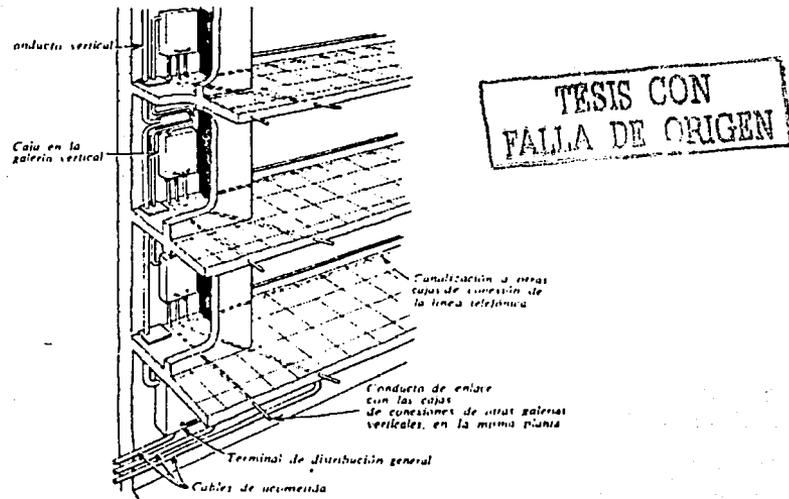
Disposición típica de las galerías verticales para instalación telefónica.
